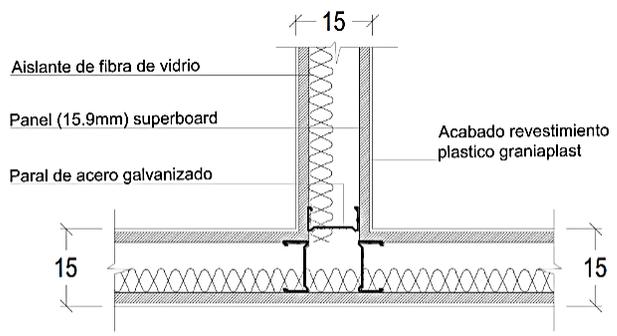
detalle sistema constructivo muros drywall FUENTE: propia
